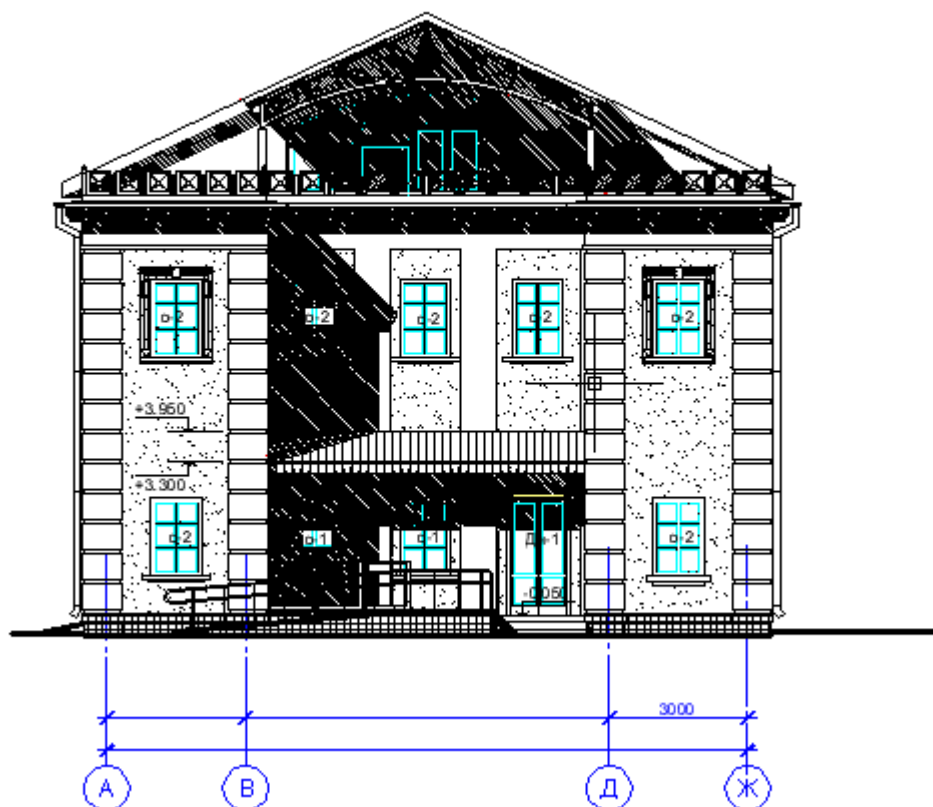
Фасад здания после реконструкции в осях А-Ж
